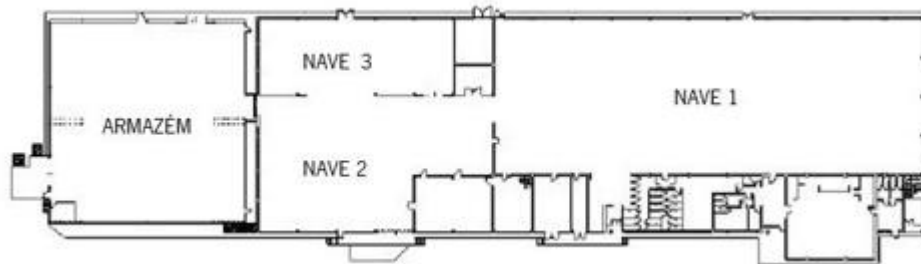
Layout do piso inferior da Gewiss Portugal.
